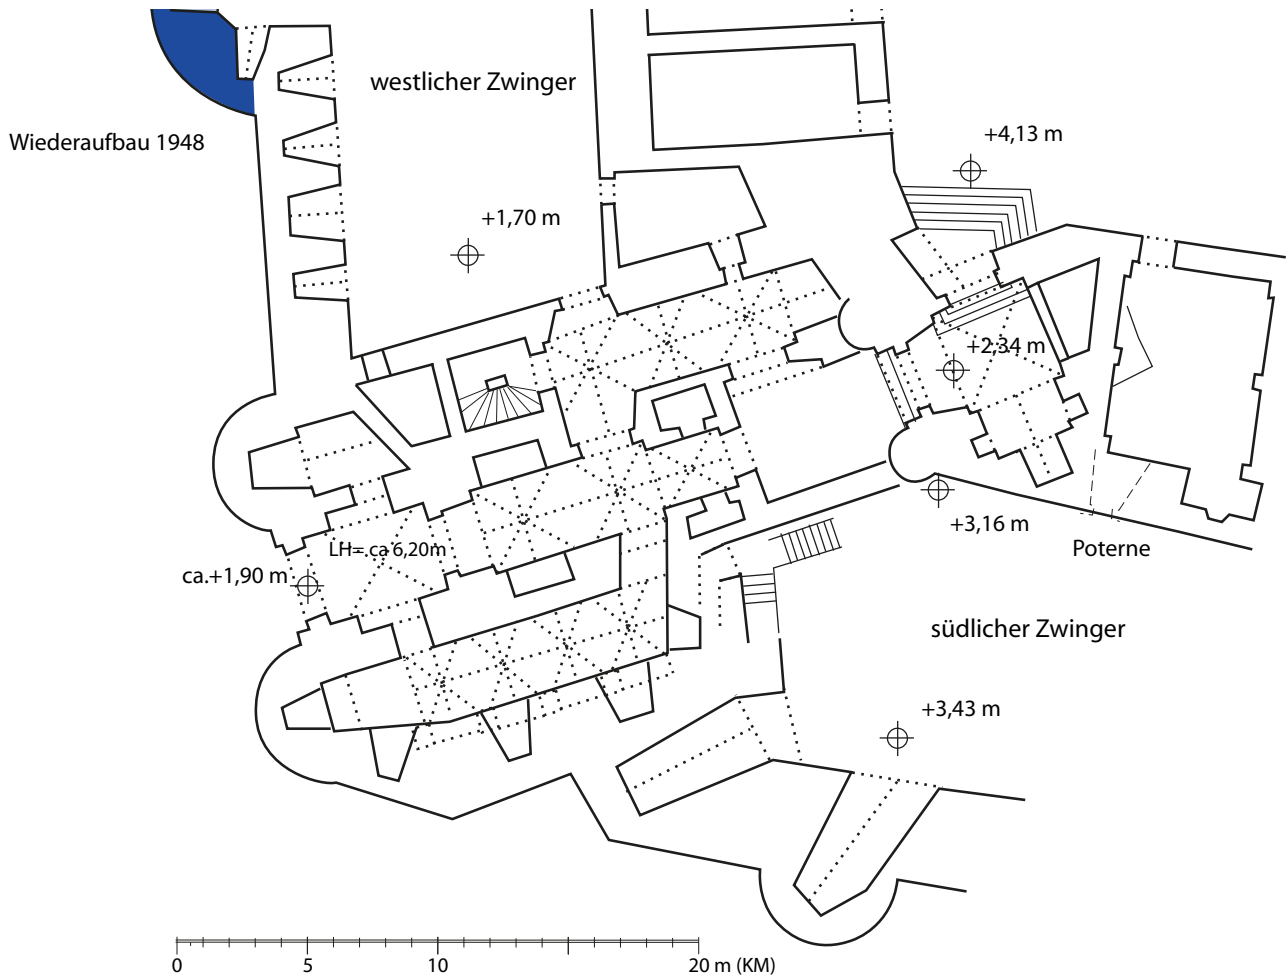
Der Torbau: aktueller Grundriss.
